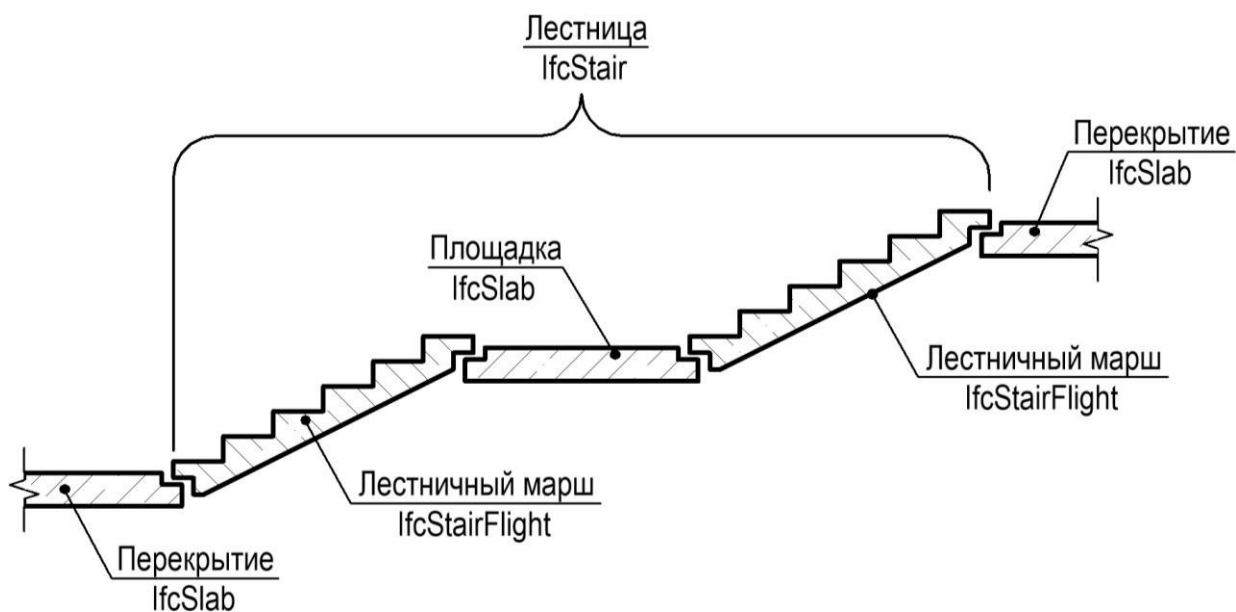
Пример моделирования сборных железобетонных лестниц
